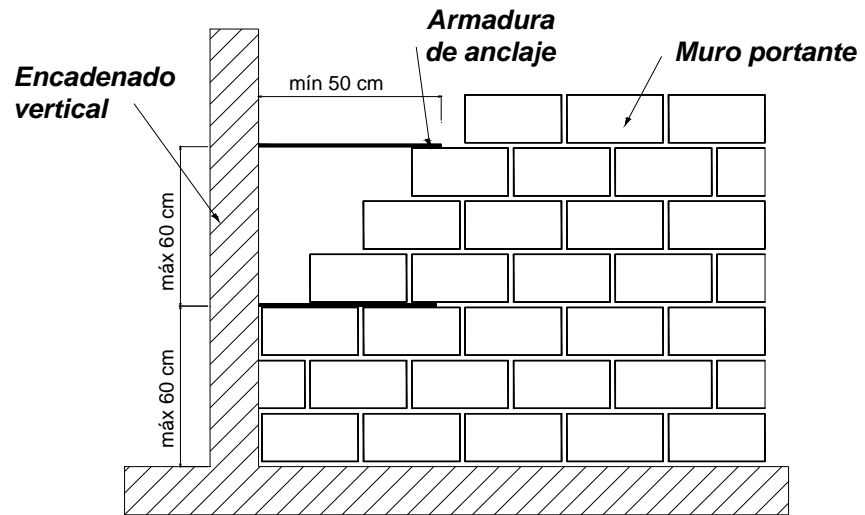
Armaduras de anclaje en encuentros de muros.
